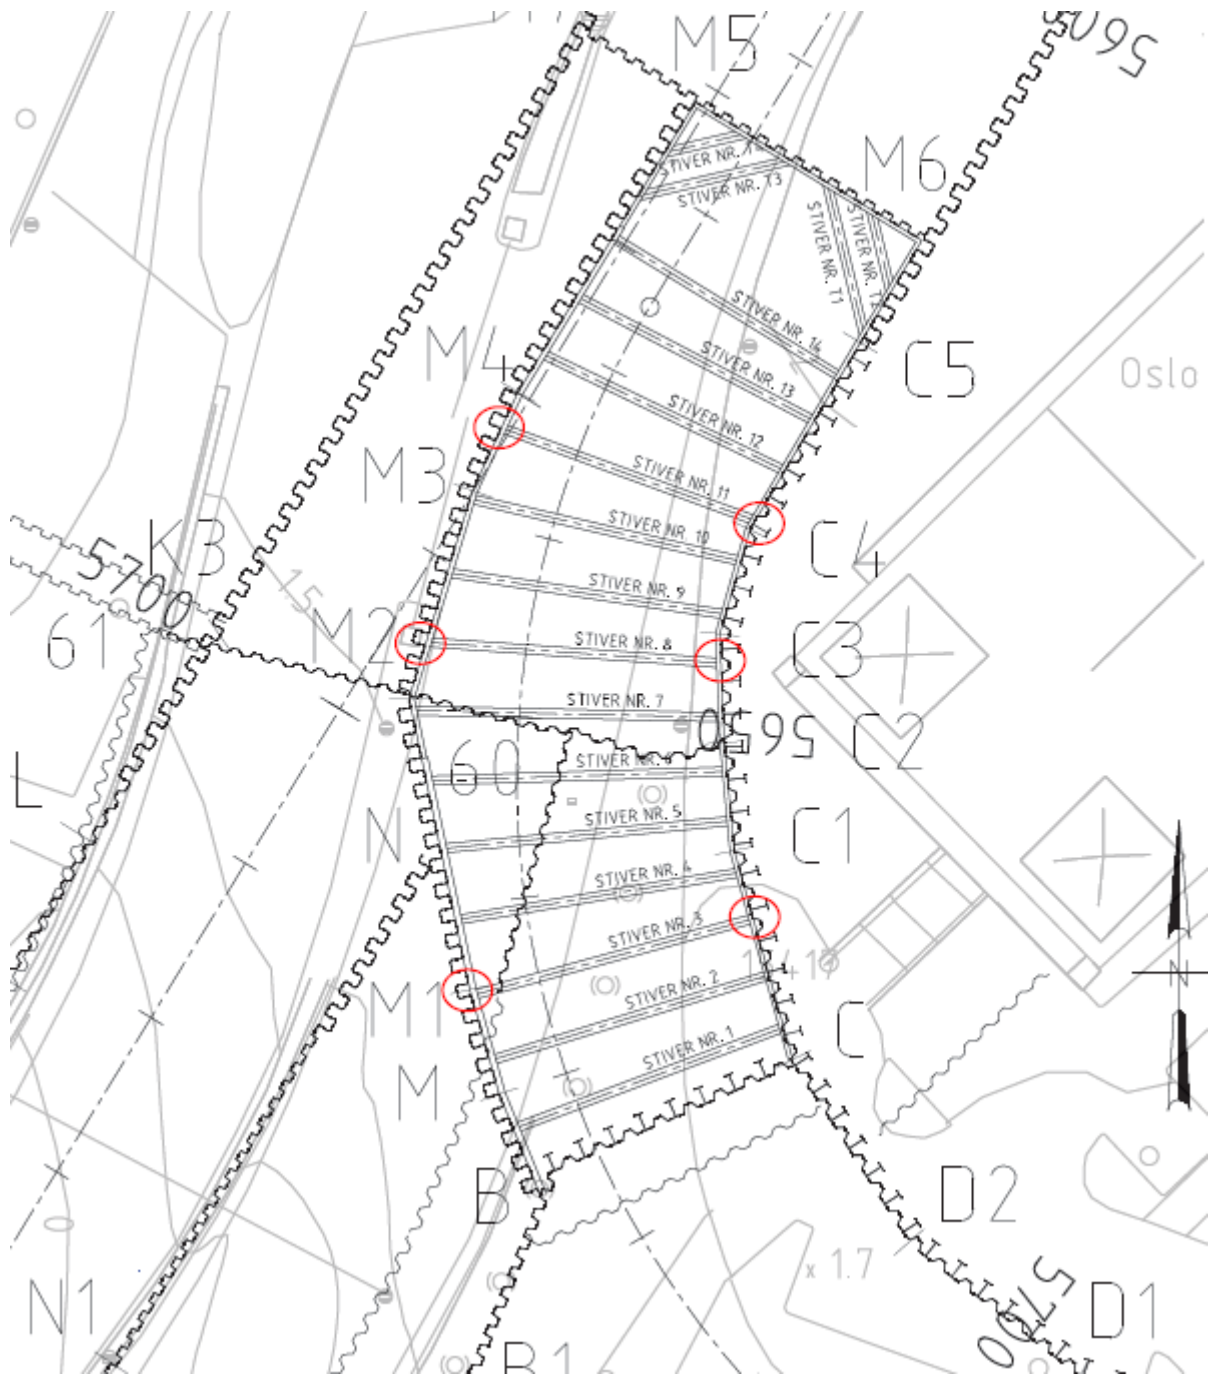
Opprinnelig forslag til instrumentering av avrampe til Rådhusgata
